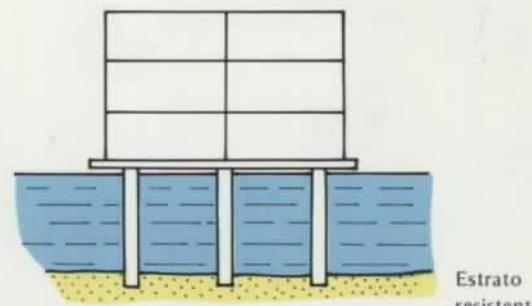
Pilotaje en áreas con capacidad de carga muy baja.
